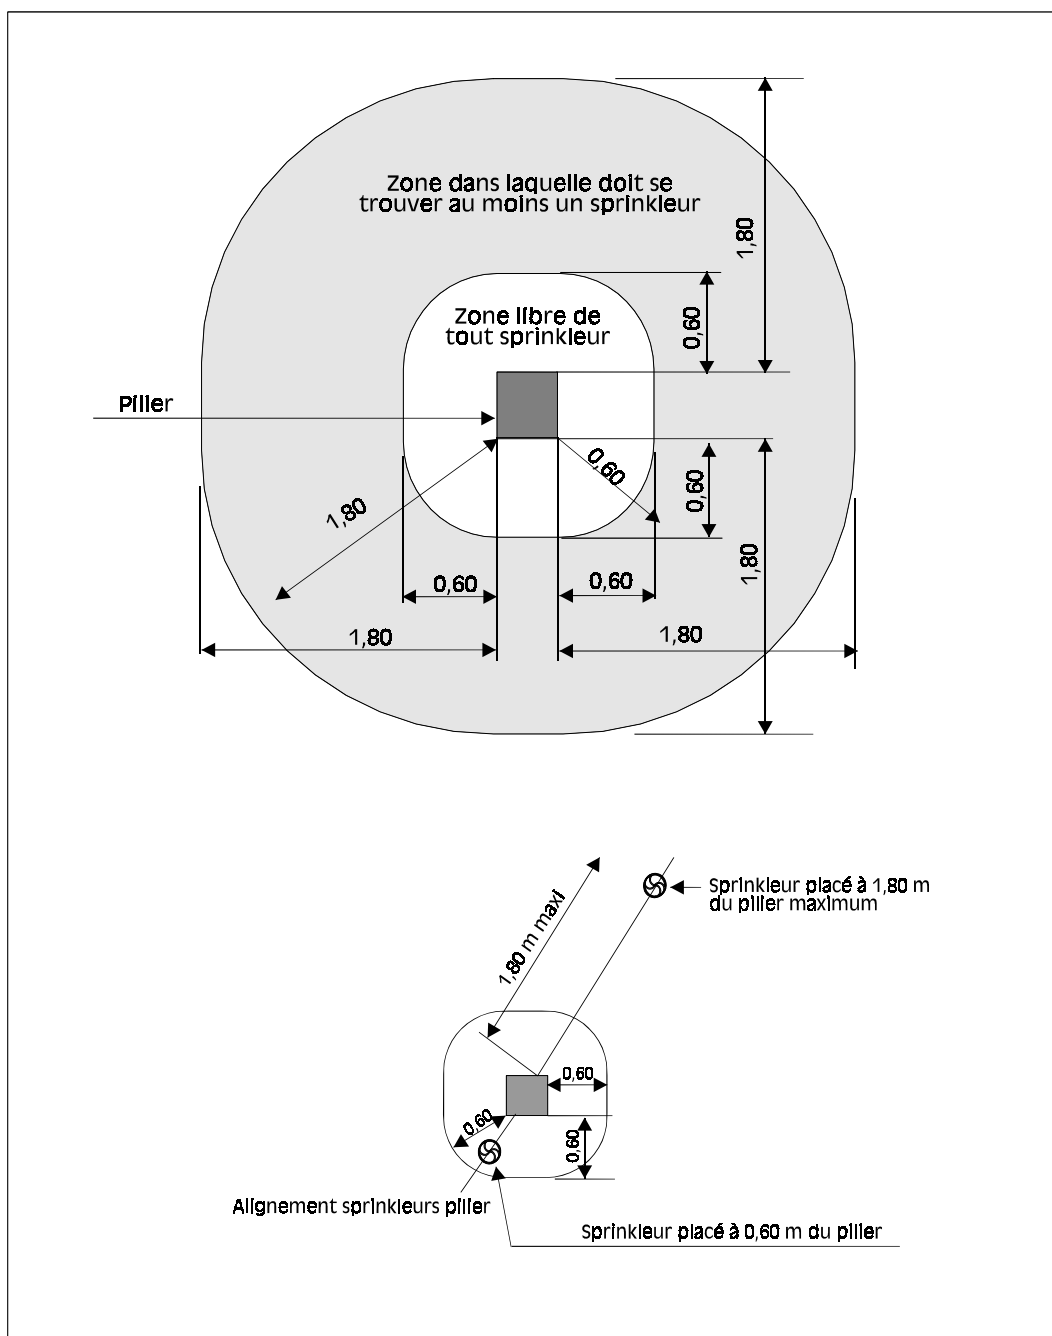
Implantation des sprinkleurs par rapport aux piliers
